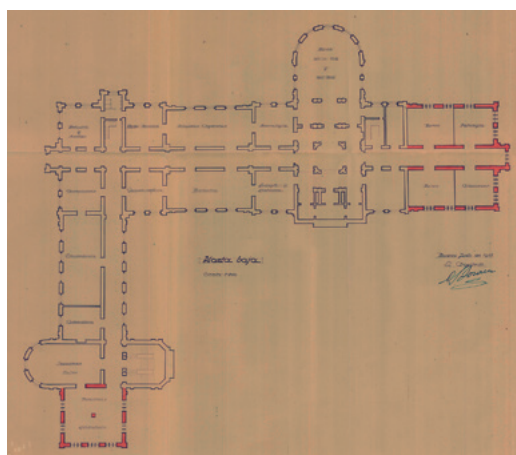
Proyecto de reconstrucción de la Escuela de Agrónomos. Planta baja. Eugenio Sánchez Lozano, 1942. Fuente: España. Ministerio de Cultura. Archivo General de la Administración. Fondo Ministerio de Educación, IDD (05)001.008.002, Caja 32/17243.
